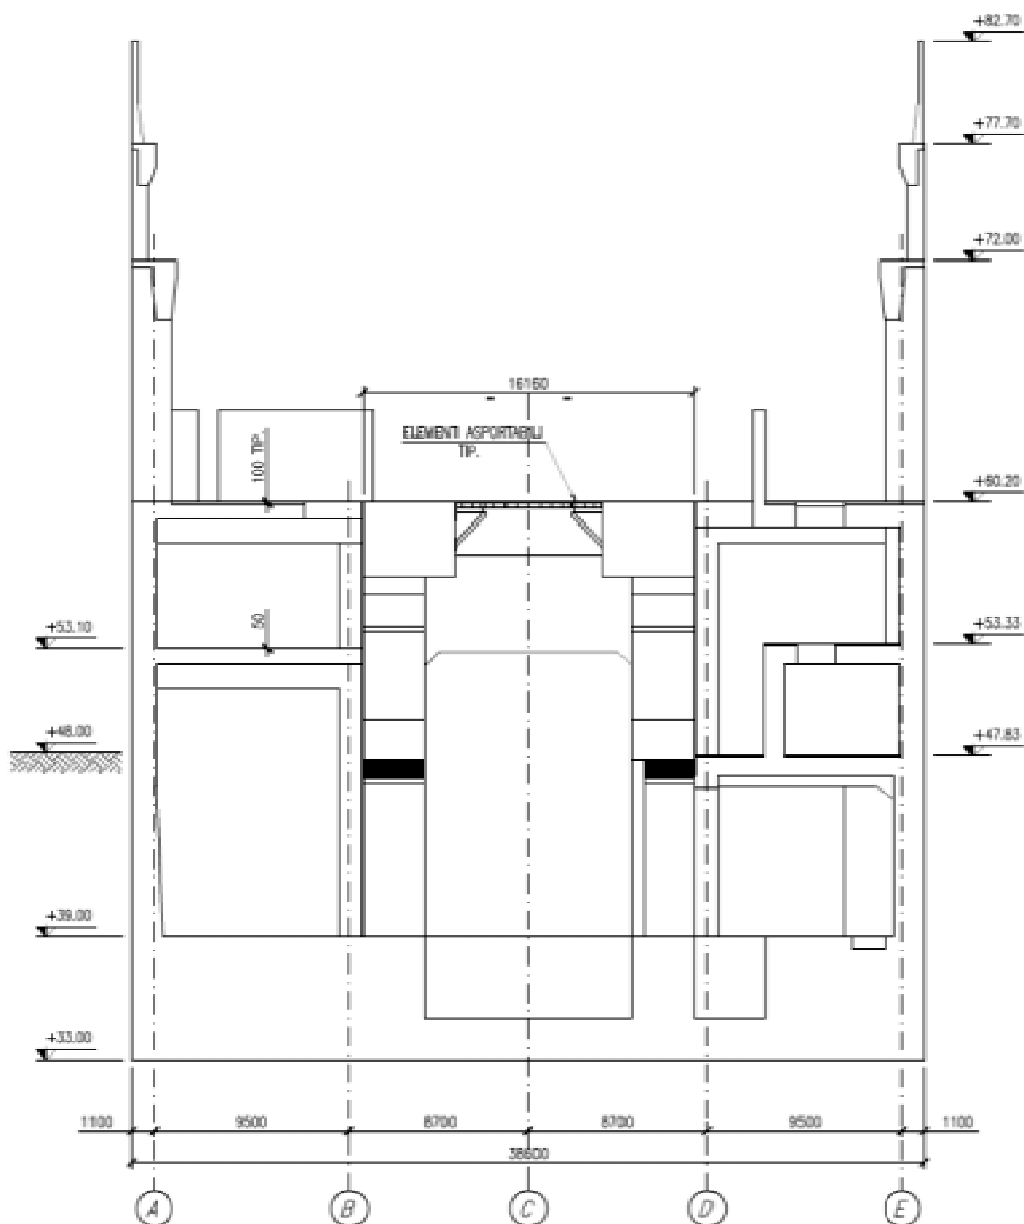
Sezione trasversale Edificio Turbina (parte in c.a.)
